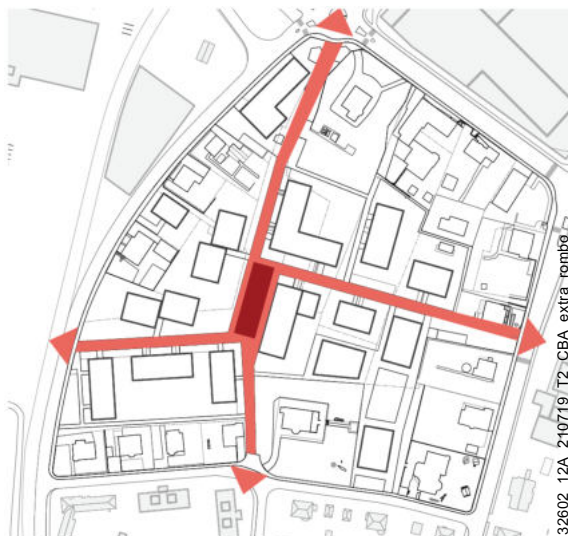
Wegsystem Team camponovo baumgartner architekten, Stand Schlussworkshop
